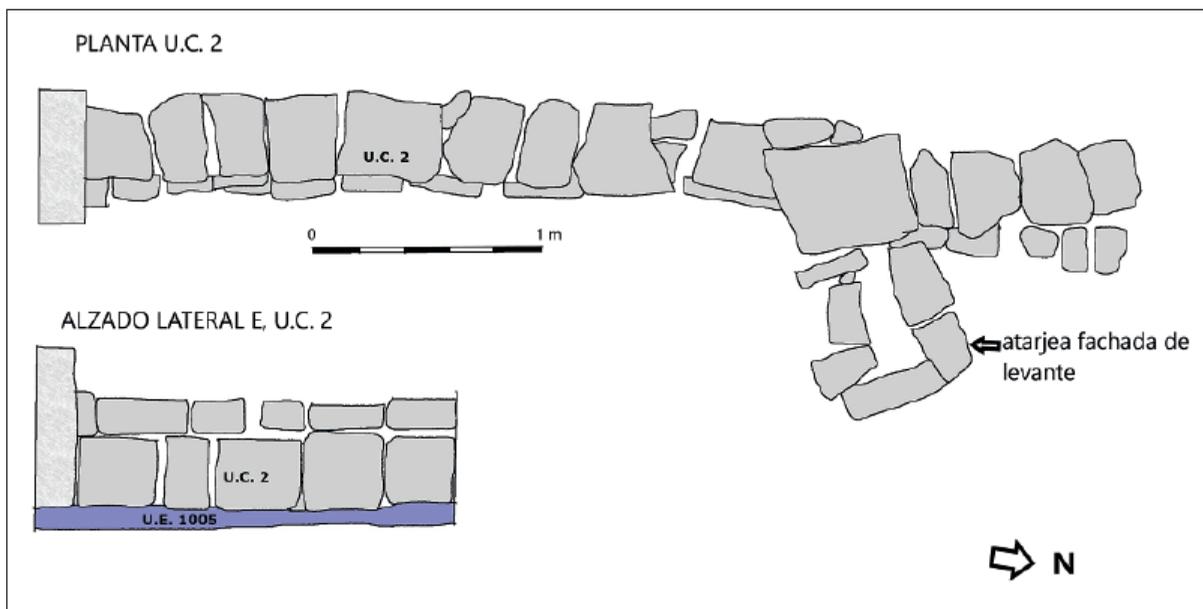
Planta y sección (detalle del extremo sur) de la cloaca (UC 2).
